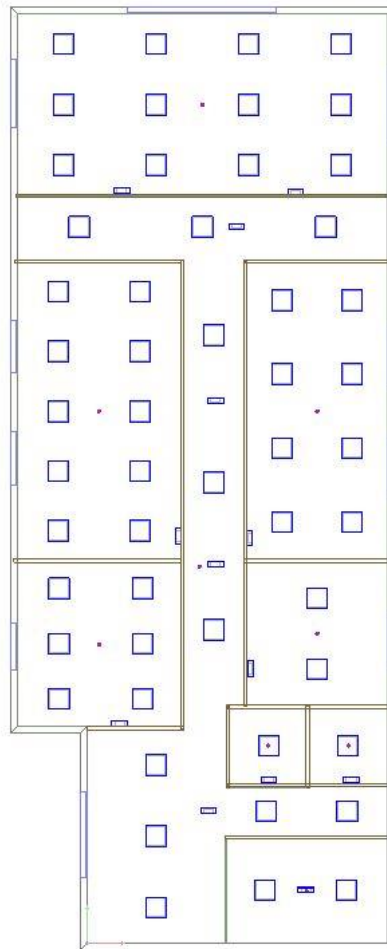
Ubicación de las luminarias en la planta Alta.
